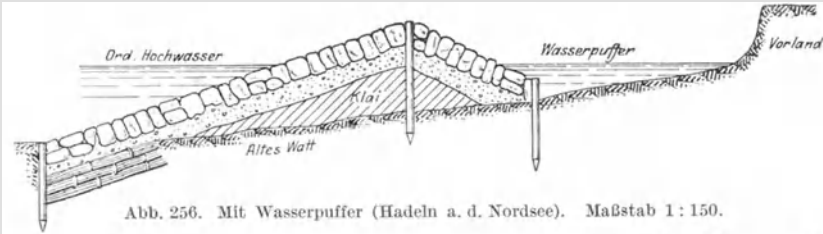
Mit Wasserpuffer (Hadeln a. d. Nordsee). Maßstab 1 : 150.
